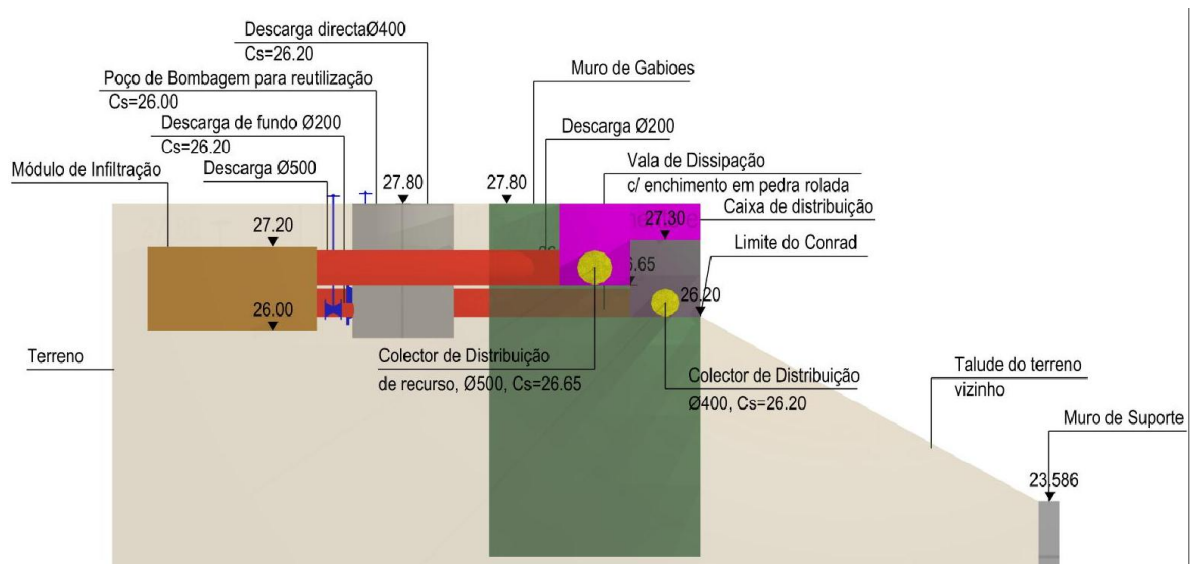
Corte transversal da ligação da bacia de retenção (a castanho), ao sistema de drenagem pluvial.
